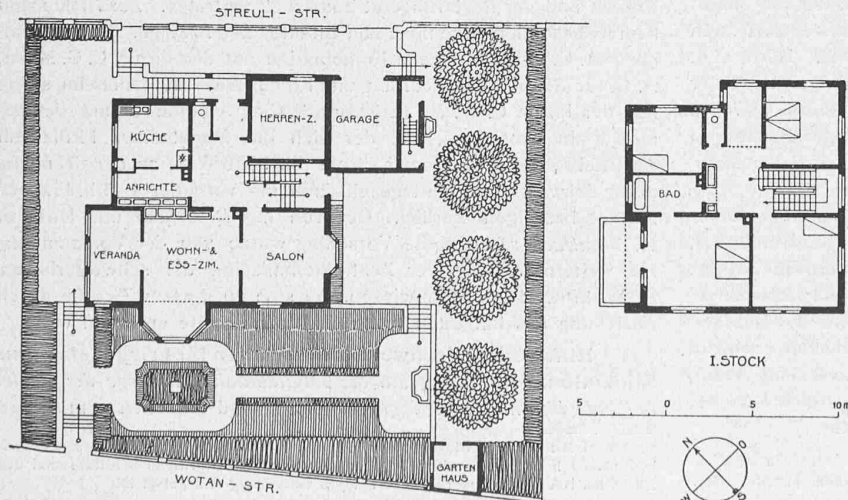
und 24. Einfamilienhaus Streulistrasse 54. — Grundrisse 1 : 400.
